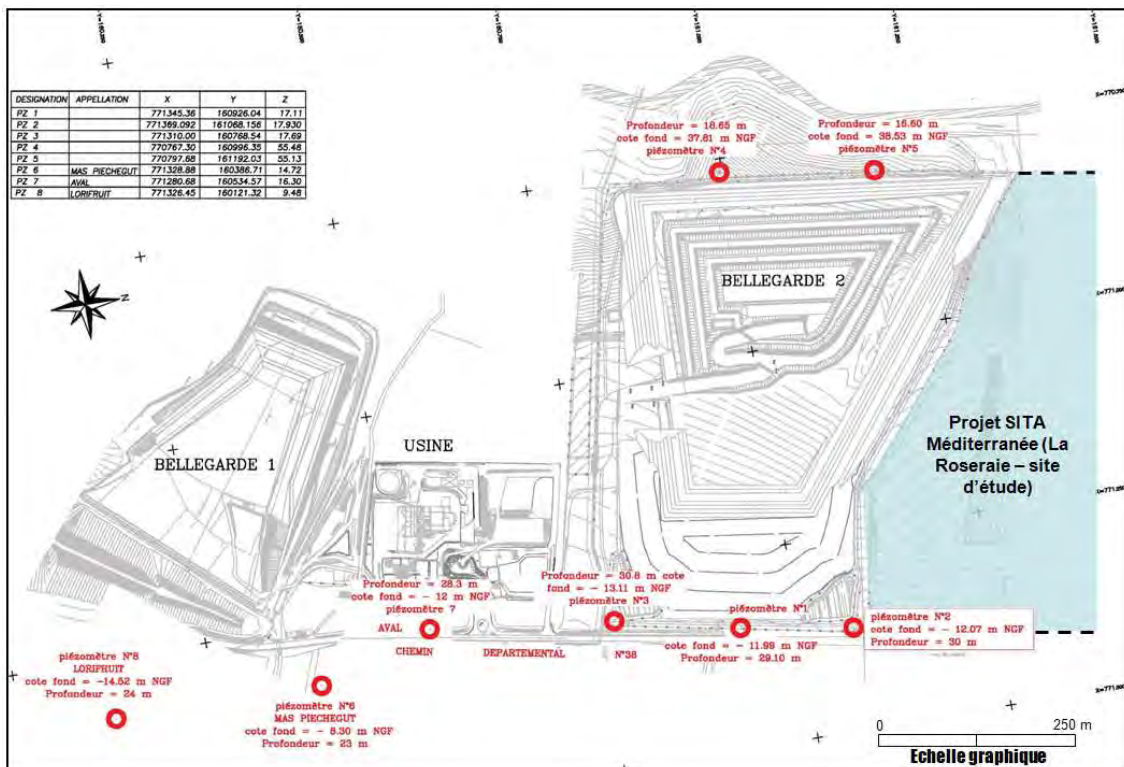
is : Localisation des piézomètres de Bellegarde 2 et leurs principales caractéristiques sur fond de plan topographique
